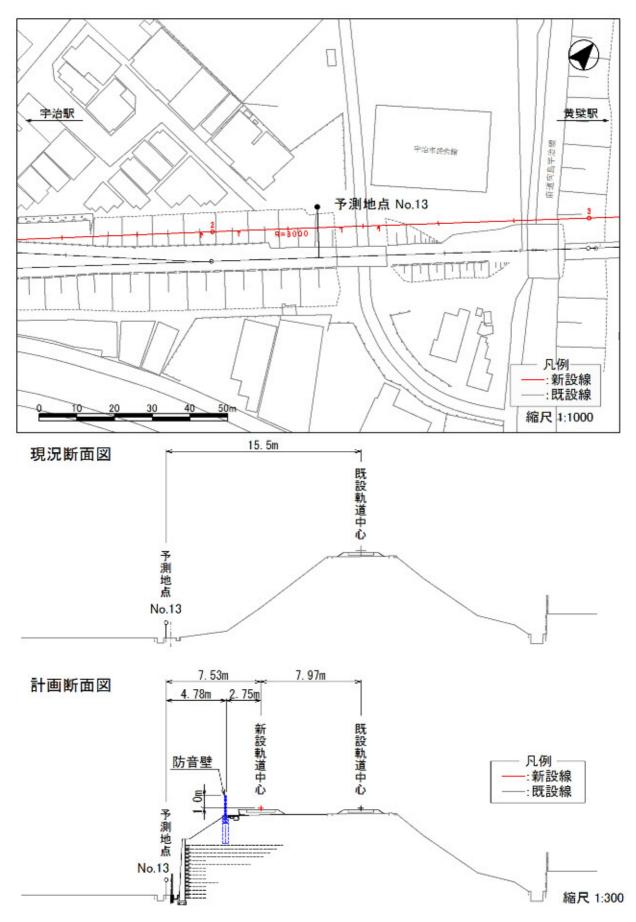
(13) 予測平面·断面図(予測地点 No.13)
